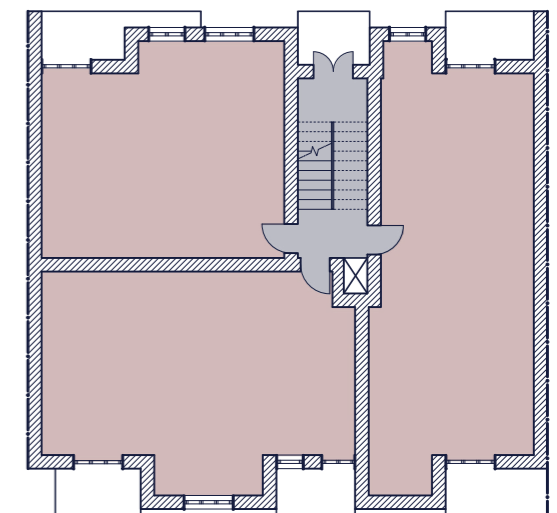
Zone termiche pianta piano tipo, fuori scala.
